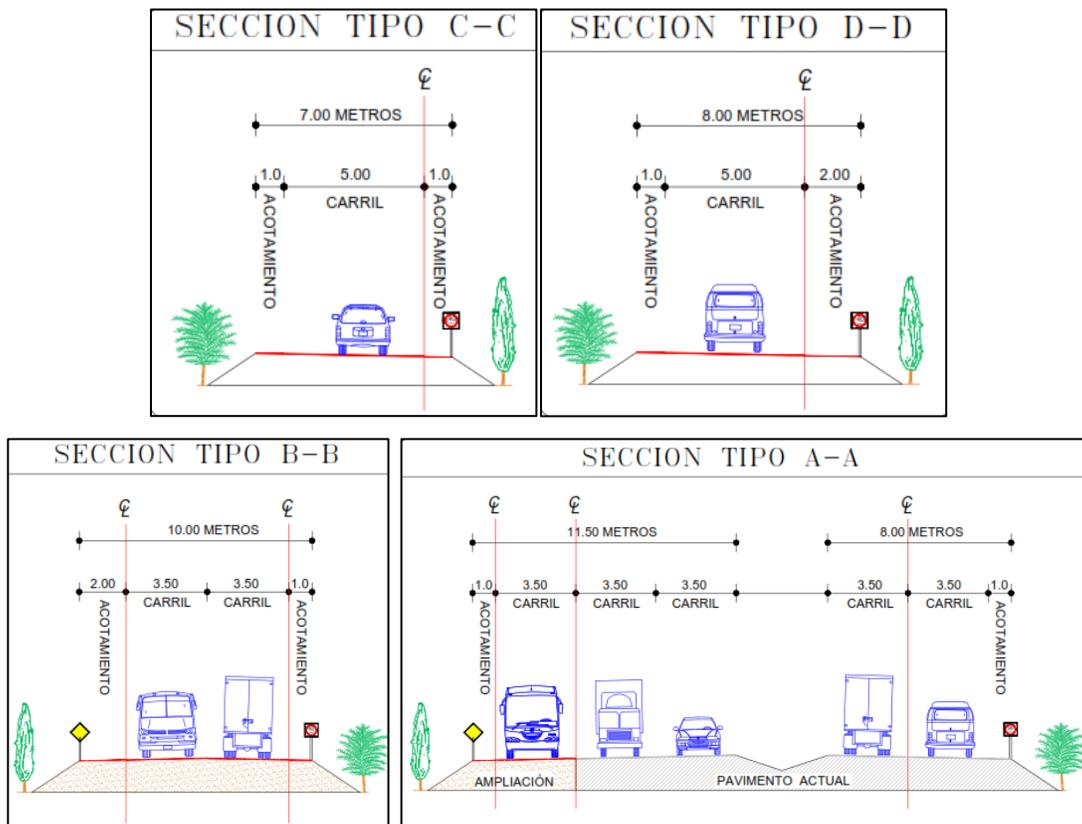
Secciones Tipo: a) Sección Tipo C-C Entrada, b) Sección Tipo D-D Salida, c) Sección Tipo B-B Carretera a Itzoteno y d) Sección Tipo A-A Autopista Federal 140.
